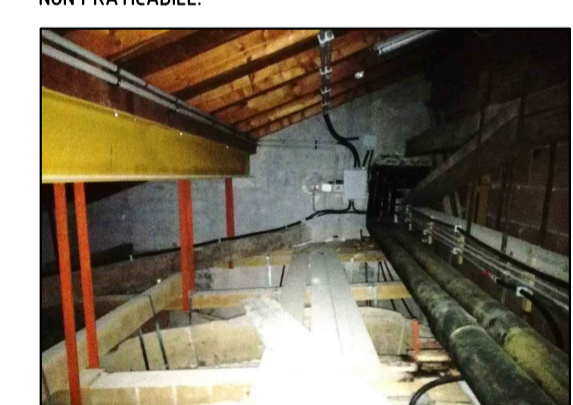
, ZONA 1C COPERTURA INCLINATA CON TRAVE METALLICA DI RINFORZO. CONTROSOFFITTO A PAVIMENTO NON PRATICABILE, CON ALCUNE ASSI PROVVISORIE.
